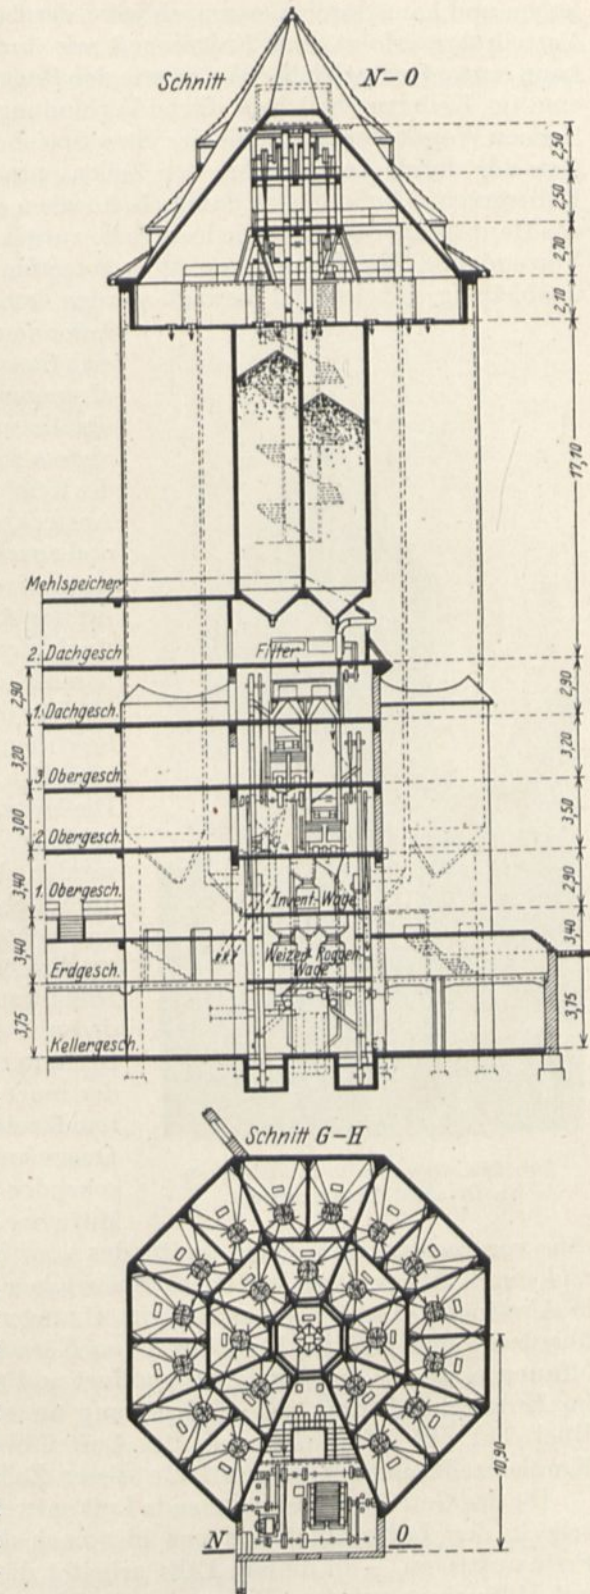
Getreidesilo in Dölzsch bei Dresden. Grundriß und Höhengschnitt zu Abb. 287.
